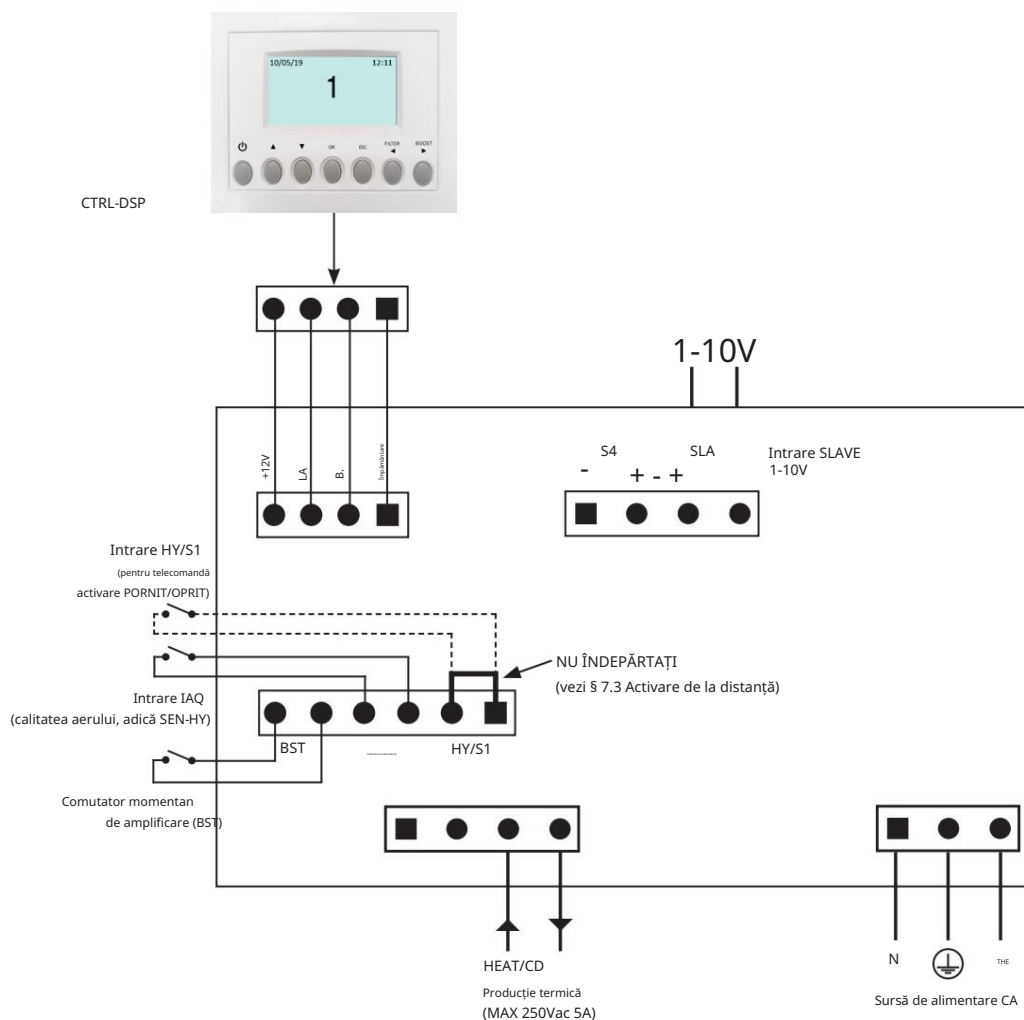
q Conexiuni electrice pe placa de bază montată în cutia de borne.
